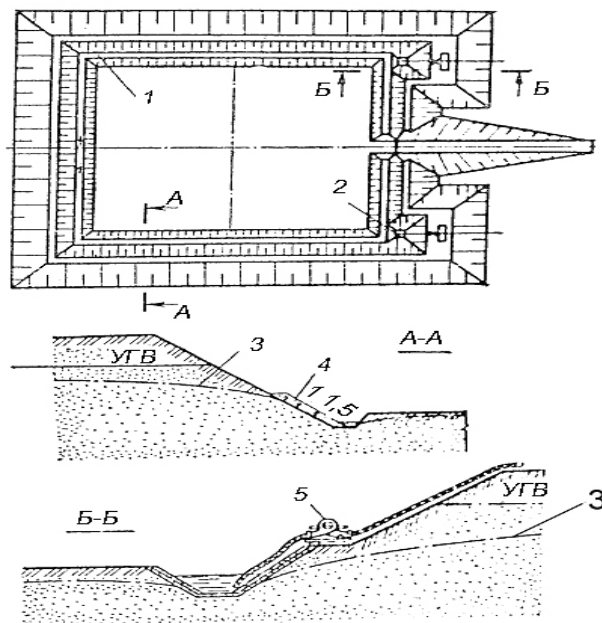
Схема відкритого водовідливу: 1 – водозбірна канава; 2 – зумпф; 3 – лінія депресії; 4 – дренажна пригрузка на укосі; 5 – насосна установка
